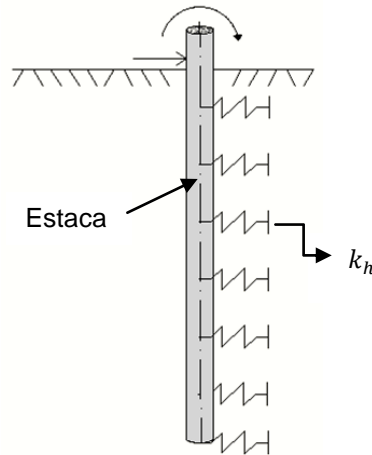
Modelo de WINKLER aplicado a estacas sob ações laterais (adaptado de LANGER 1984)
